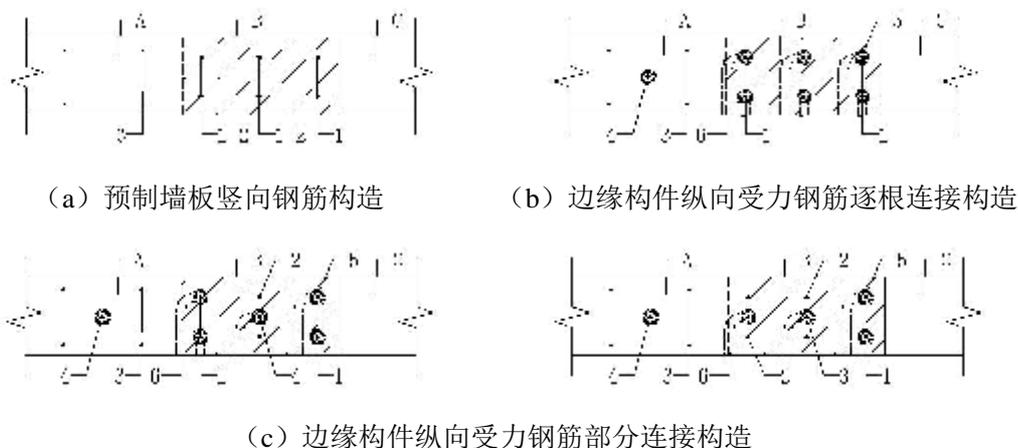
预制墙板边缘构件纵向受力钢筋构造示意
